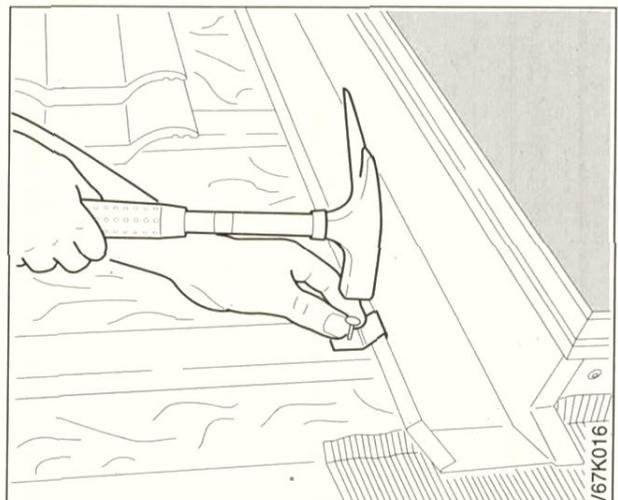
Seitenbleche mit drei Befestigungshäften auf Dachlatten festnageln.
